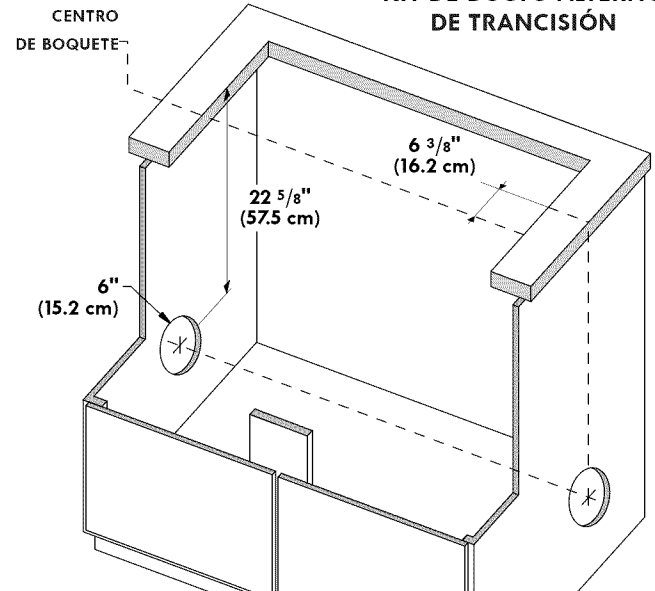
A – ORIFICIO ALTERNATIVO DE LA DUCTERÍA, MODELO DE 30 PULGADAS
